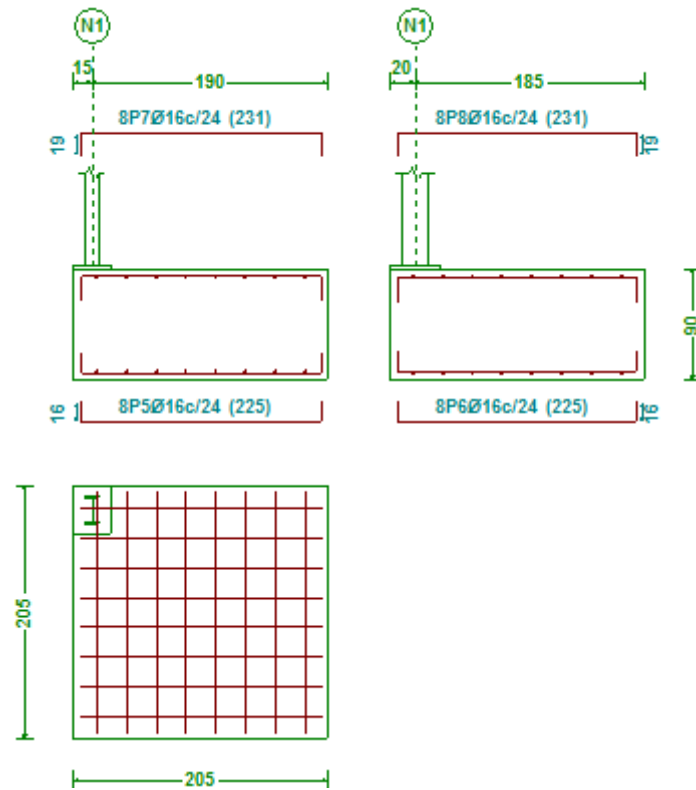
Zapata pilar exterior izquierdo del pórtico de fachada trasero (Tipo 7)
